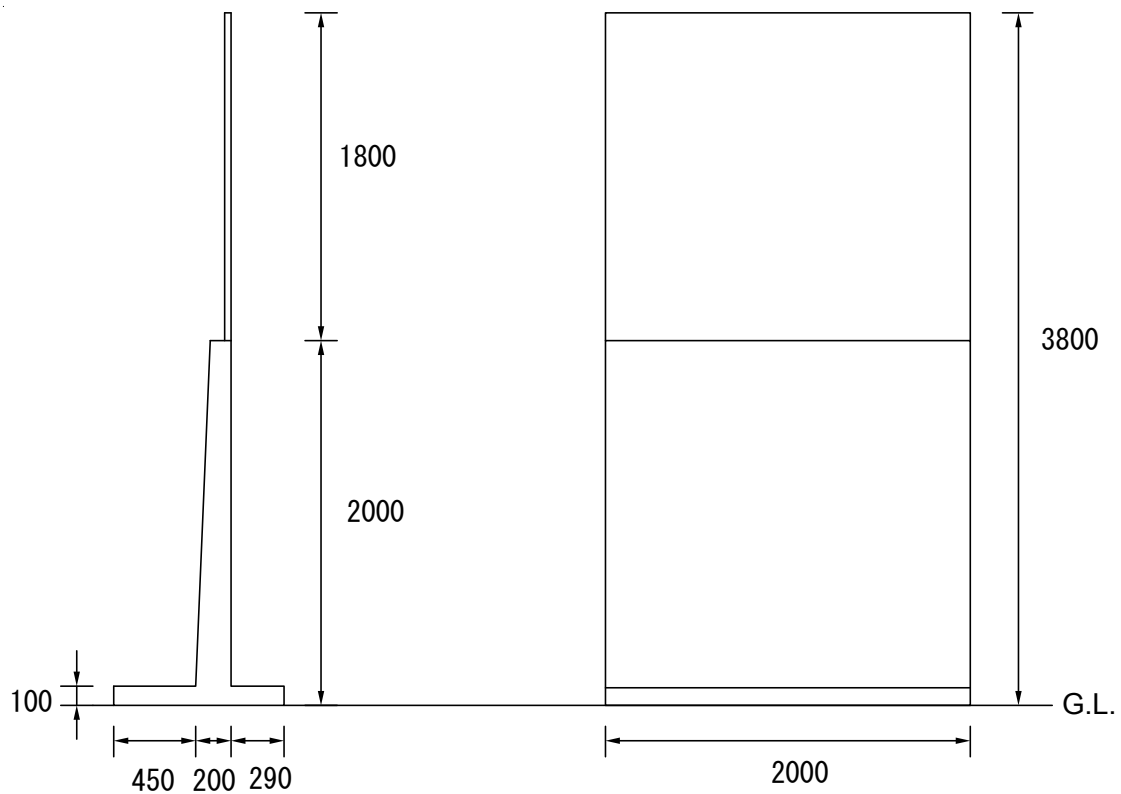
RC 塀立面図 (単位 : mm)
